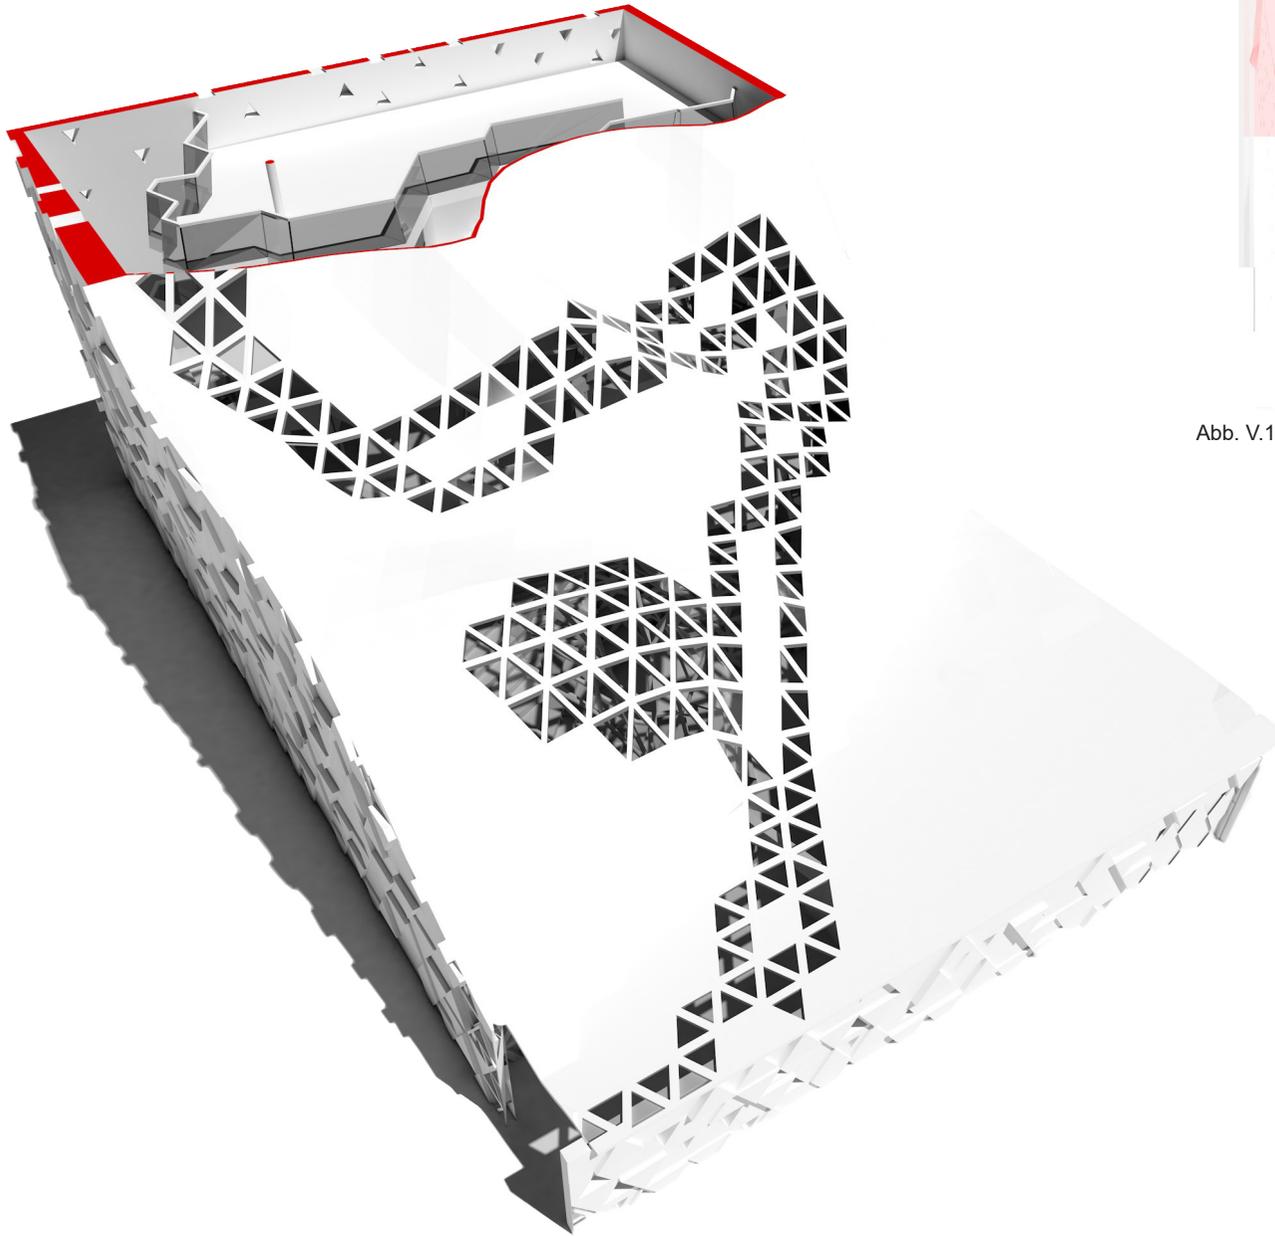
3D Darstellung 3.Obergeschoß
